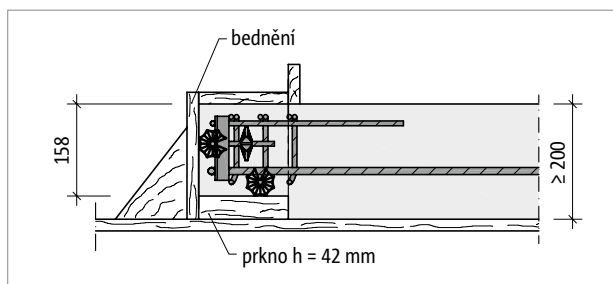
Schöck Tronsole® typ Z: Provedení úložné konzoly u plně prefabrikované podesty; tloušťka podesty $h = 160$ mm
